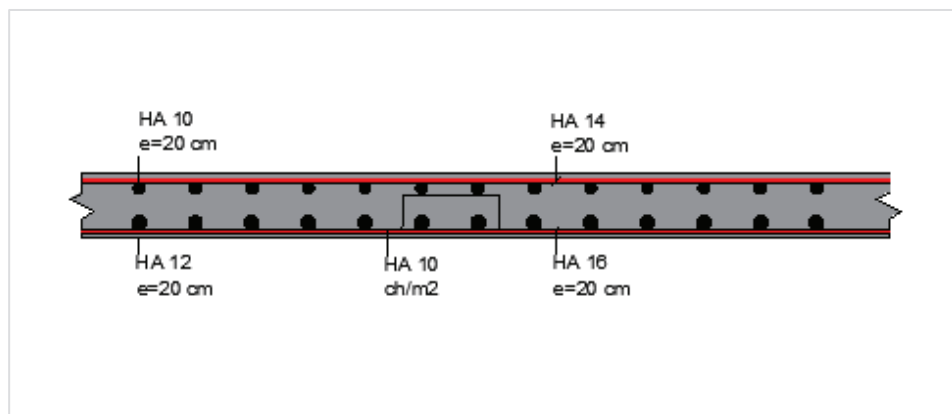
Ferrailage de la dalle (coupe transversale).
